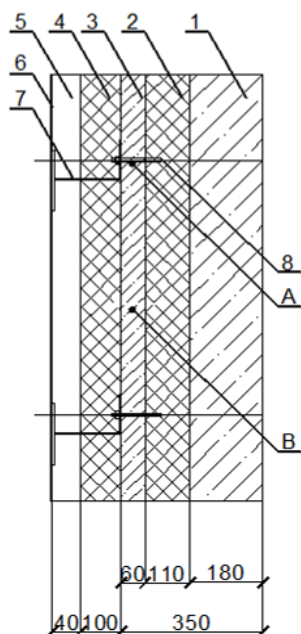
Конструкция сборной трехслойной железобетонной панели с навесным вентилируемым фасадом:
